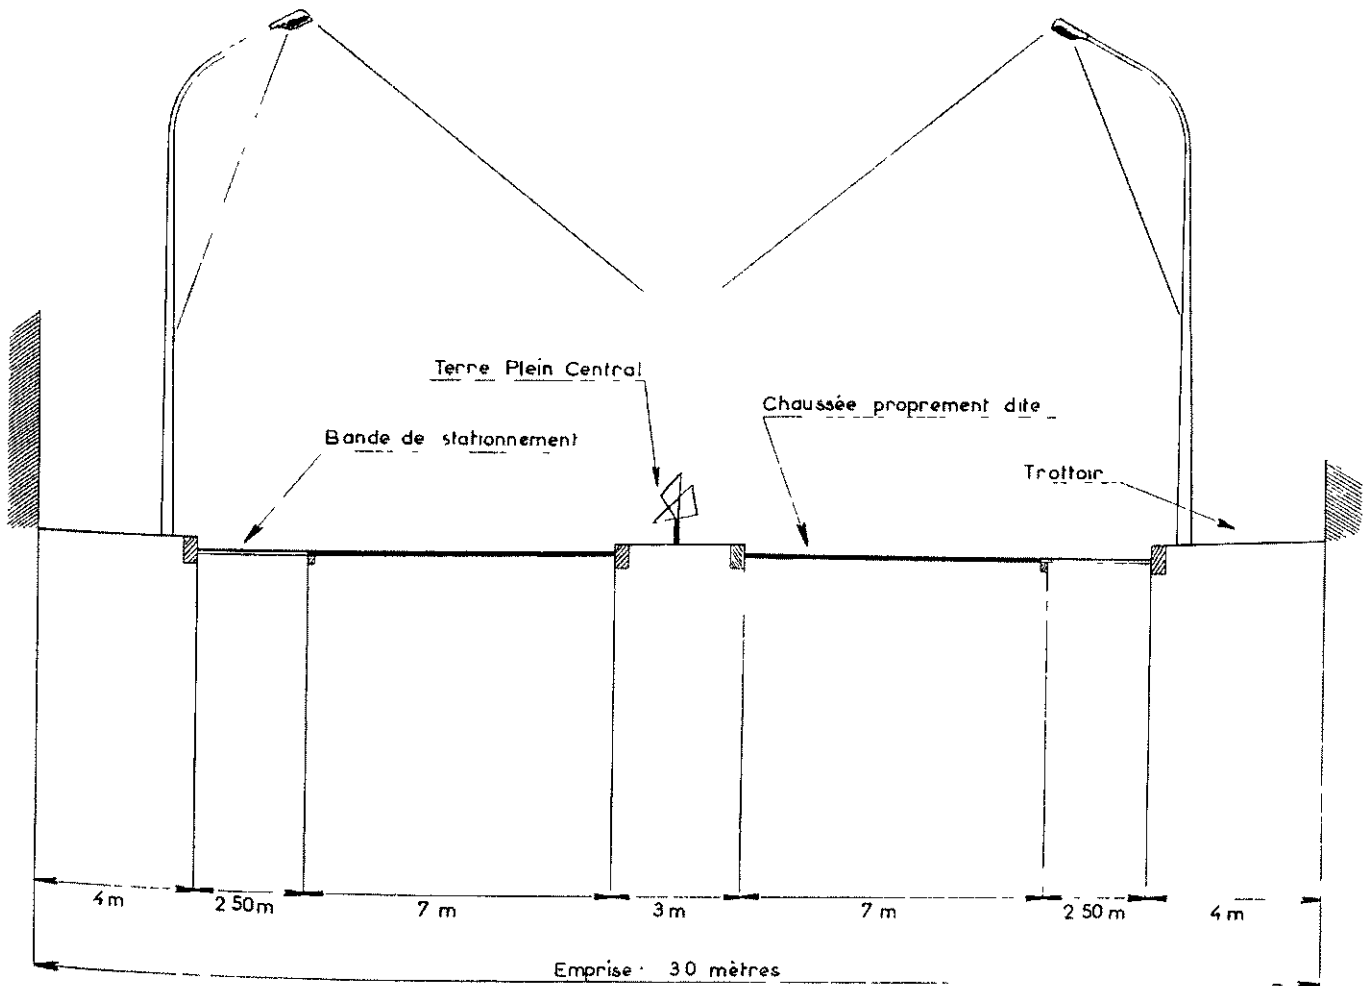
Profil en travers — type d'un aménagement sur place :
